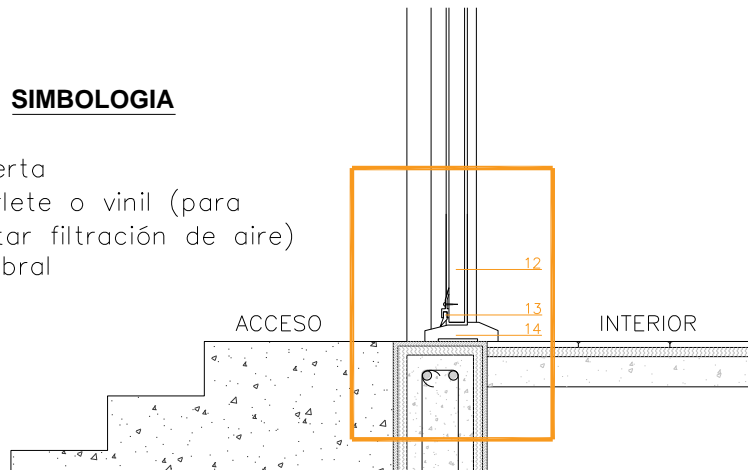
Diseño y detalle corte de la puerta de acceso principal
